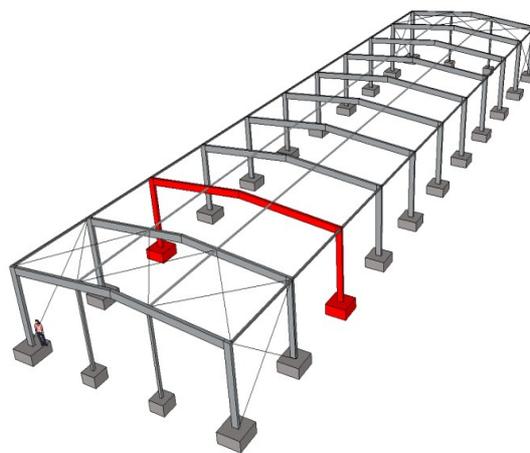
Vista prospettica del sistema strutturale di un edificio a singola elevazione, con la struttura base intelaiata, vista come unità funzionale
